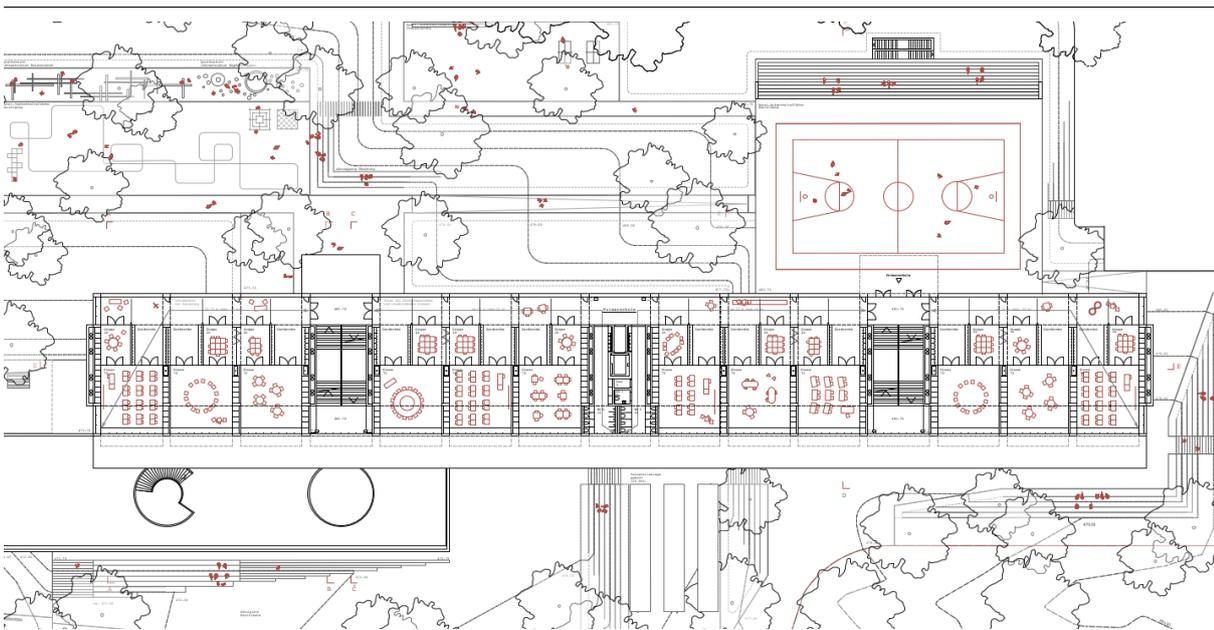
Grundriss 2. Obergeschoss
